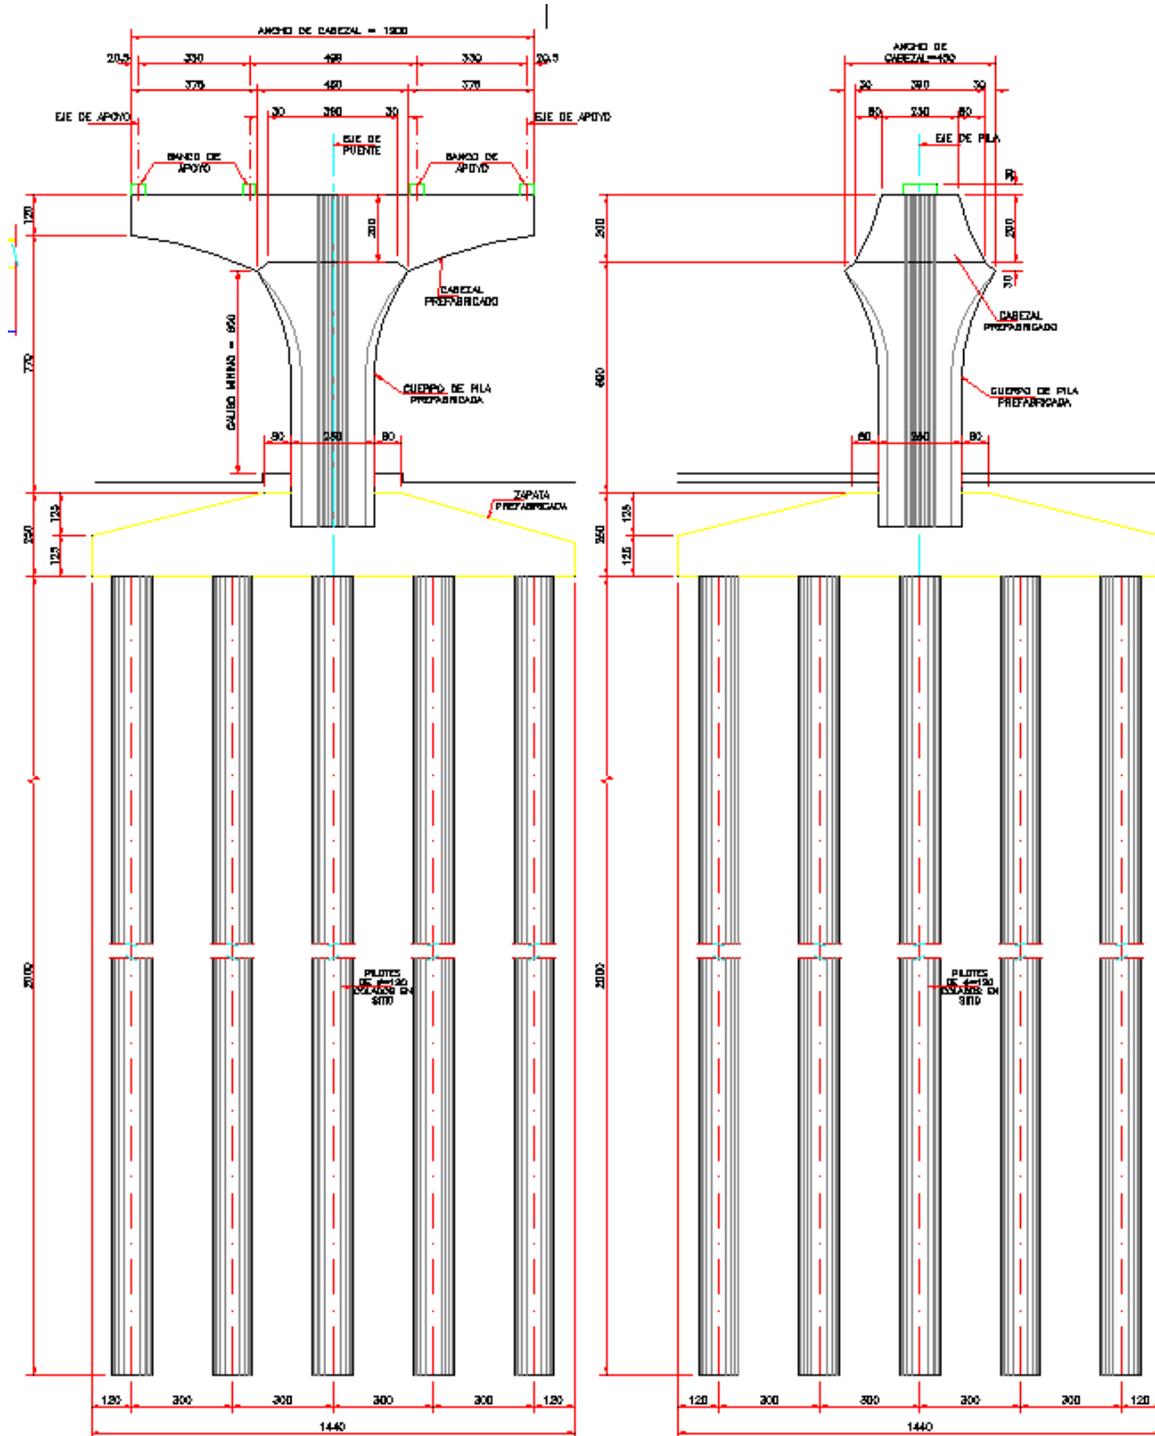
Cimentación tipo para pilotes colados en sitio de 120 cm de diámetro.
